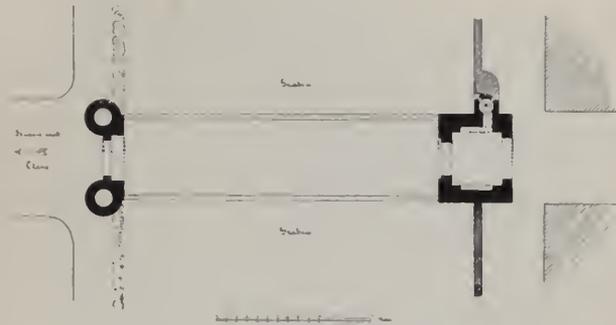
Xanten. Grundriss des Klever Thores.
